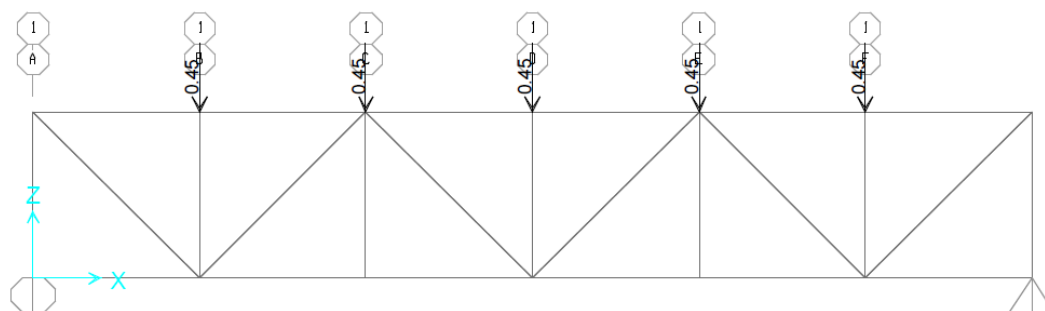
Modelo de cercha tipo Warren con módulos cada 1 m (W1m).
